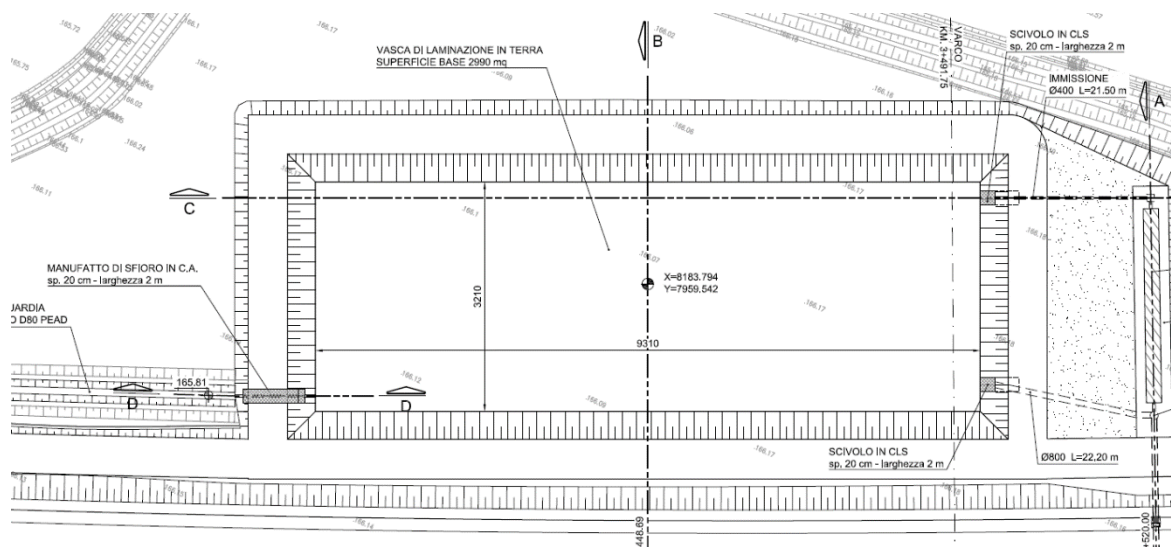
planimetria generale dell'impianto di laminazione B
